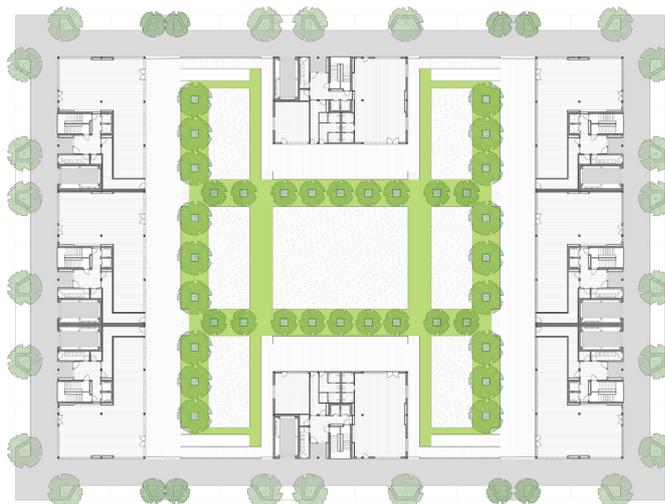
Planta do Piso Térreo do Quarteirão OCTO
